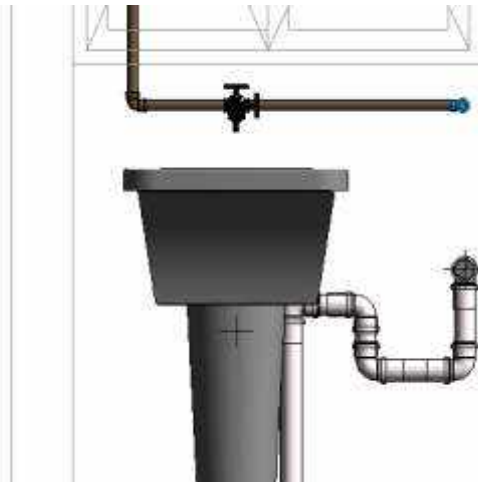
Sistema de esgoto da área de serviço (Planta baixa)
